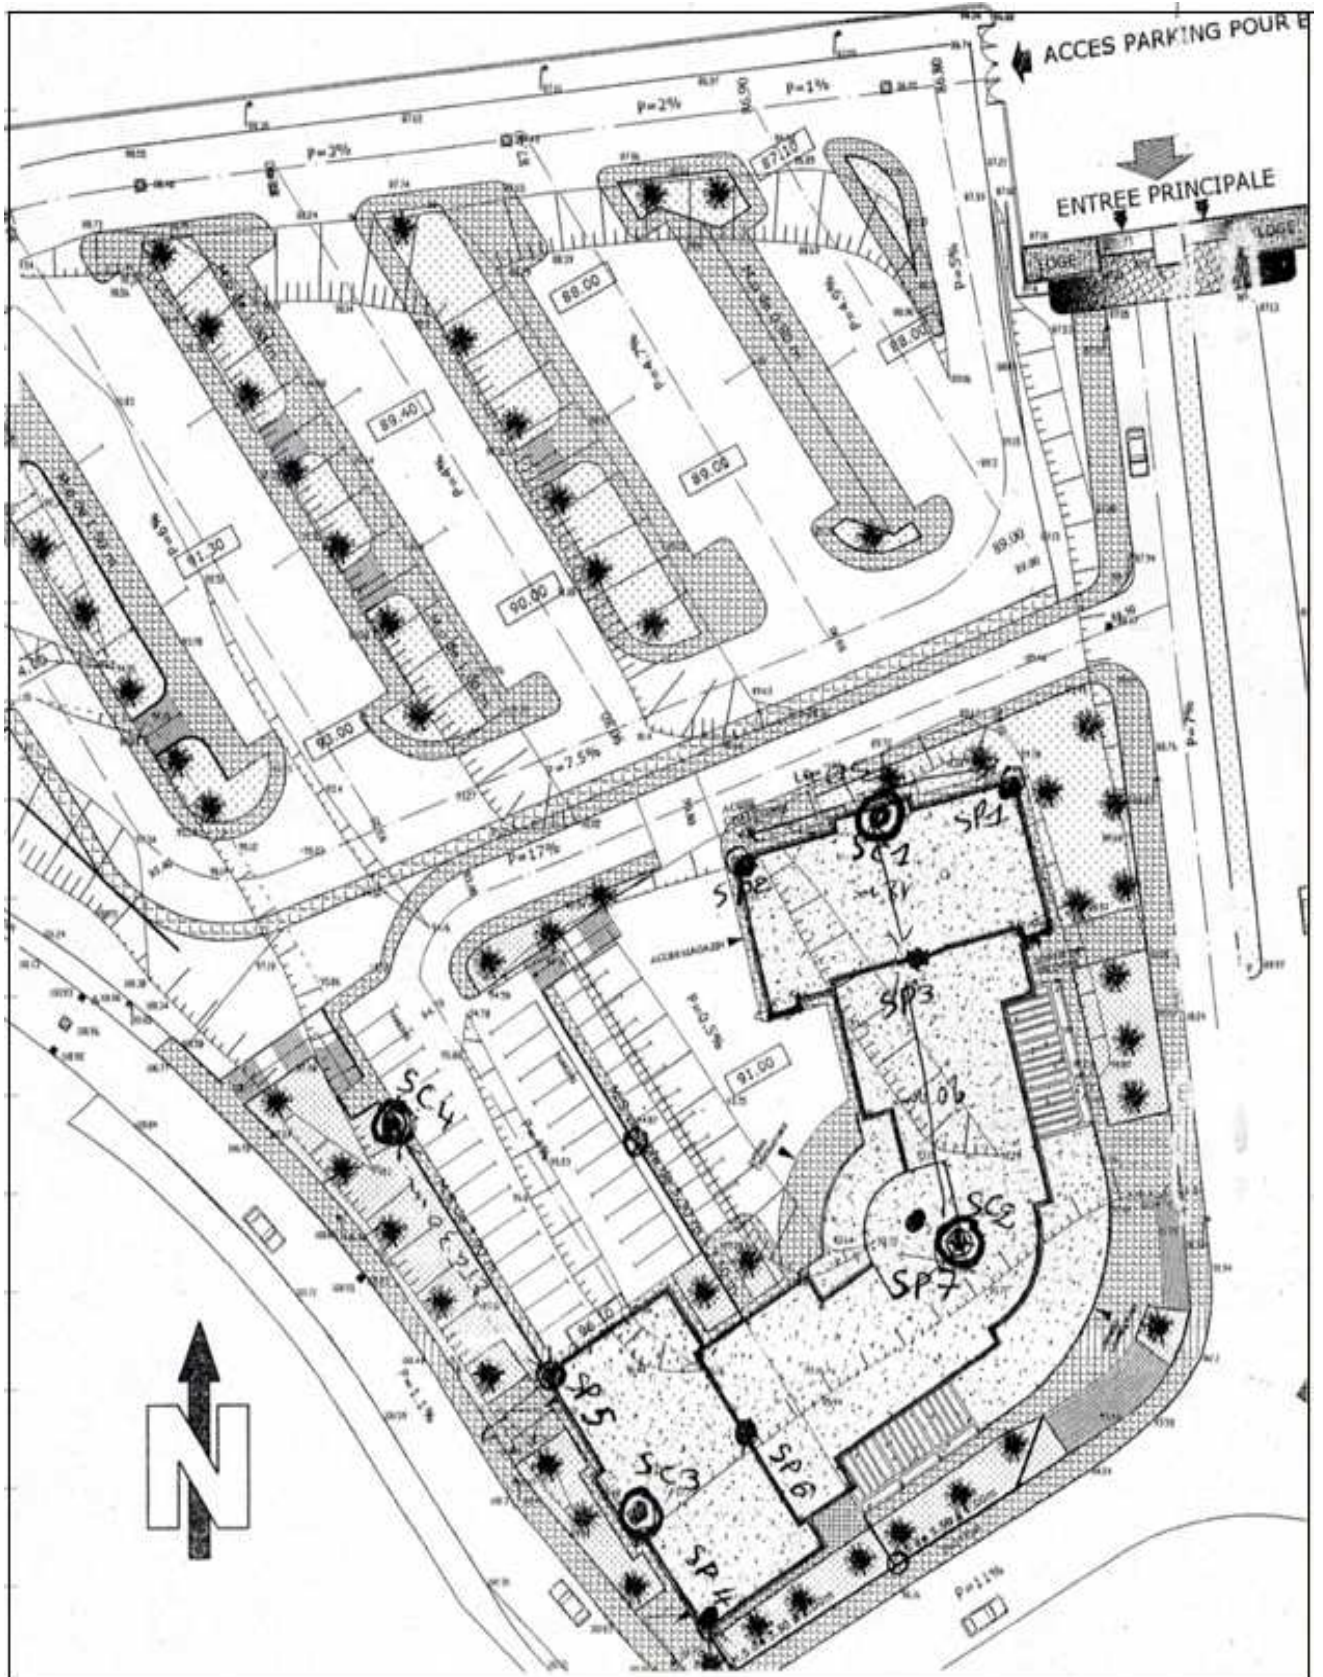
Plan du site et d'implantation des sondages (L.C.T.P 2009)
